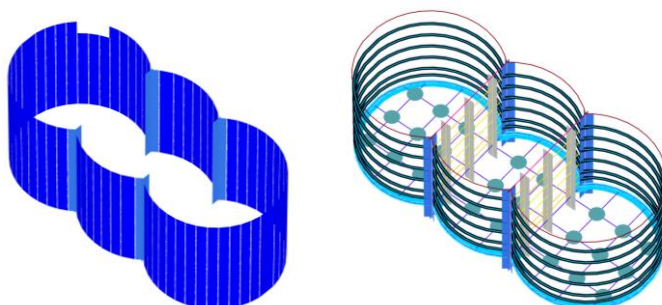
Geometria do modelo tridimensional de cálculo (PLAXIS 3D) – Elementos estruturais: parede de contenção, viga de coroamento, anéis, pórticos, vigas de fundação e sapatas.
